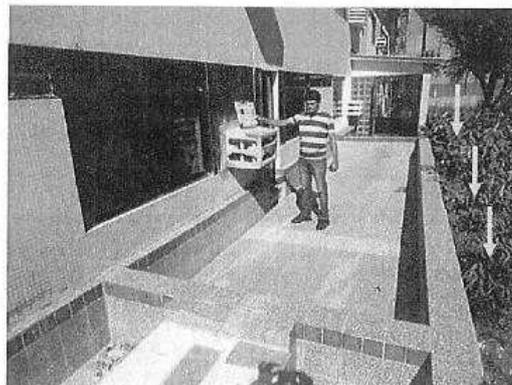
Área acrescida apoiada sobre o muro de divisa do terreno.
